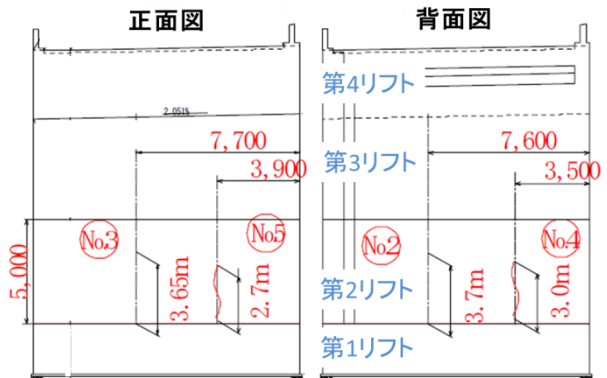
第二リフトのひび割れ状況⁶⁾
